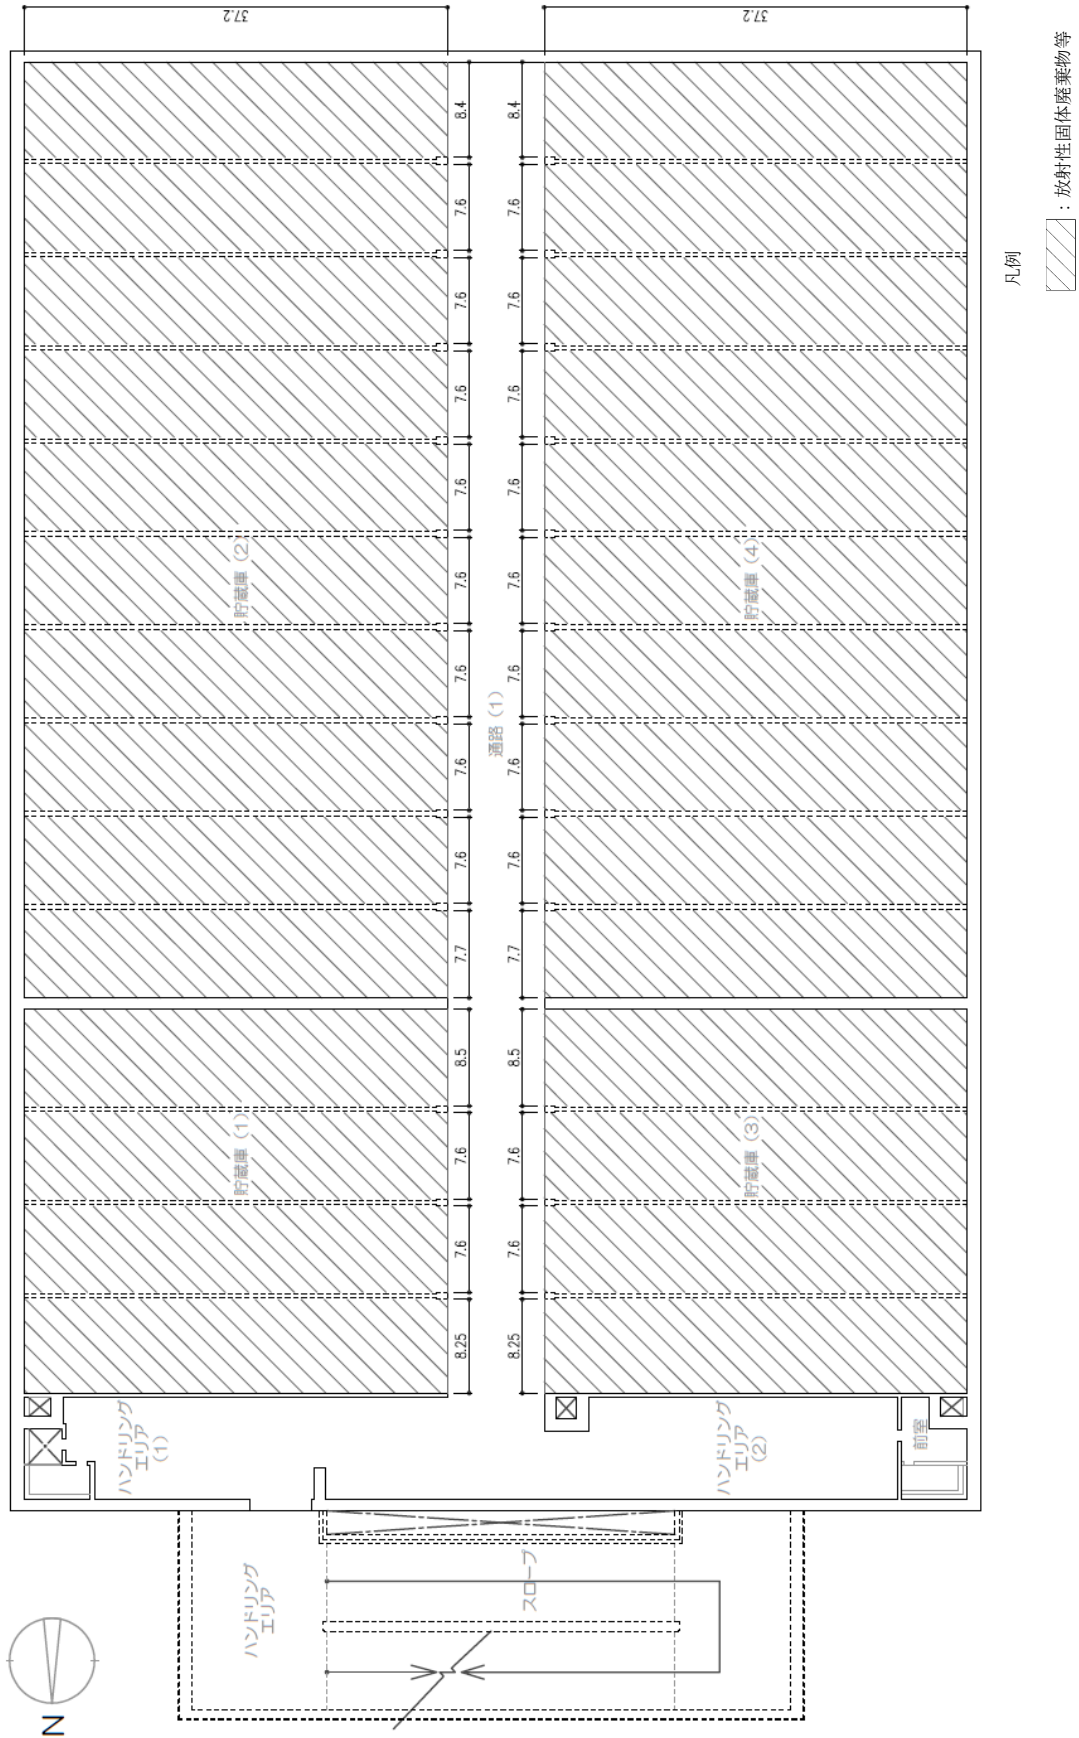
固体廃棄物貯蔵庫第11棟 4階 平面図 (単位: m)
